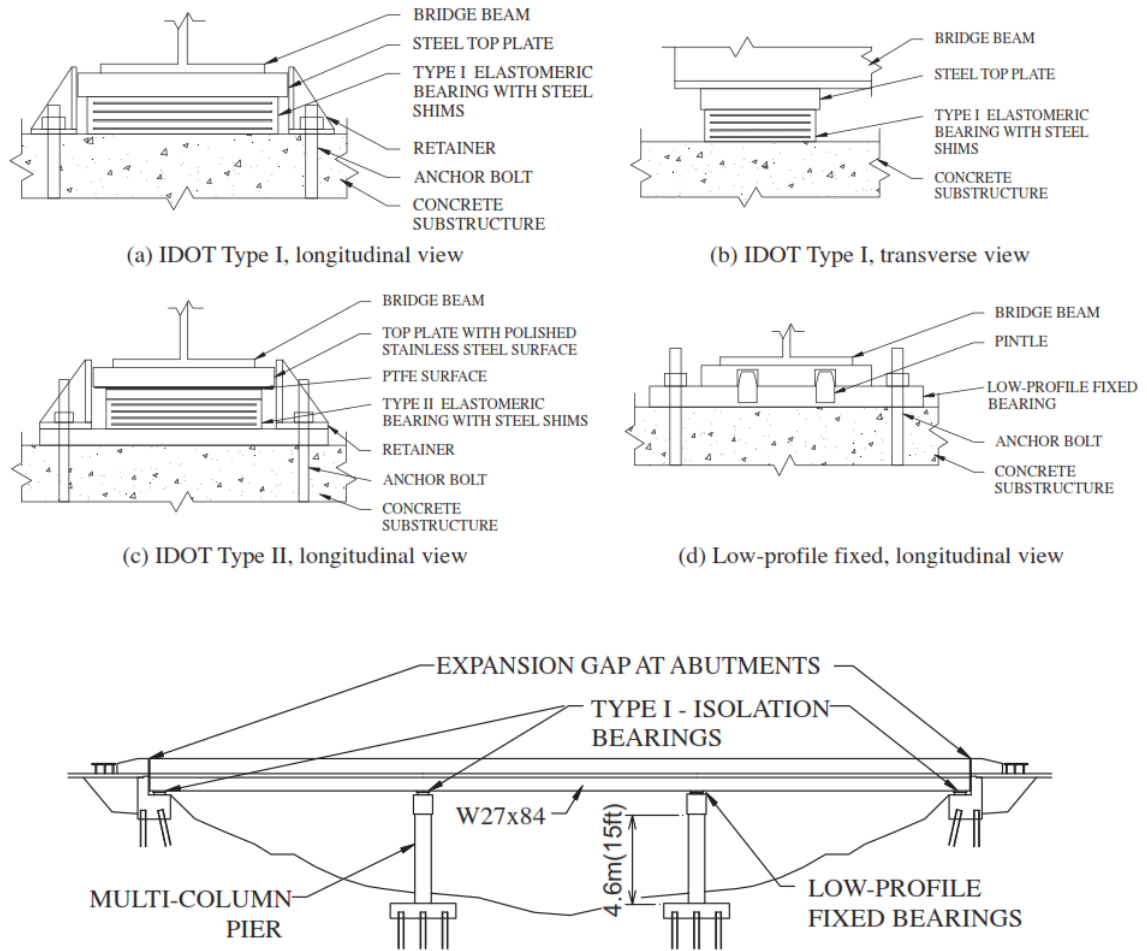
Alternativas de sistema de aislación y esquema de su colocación en la estructura (Filipov, Fahnestock, Steelman, Hajjar, LaFeve, & Foutch, 2013).
